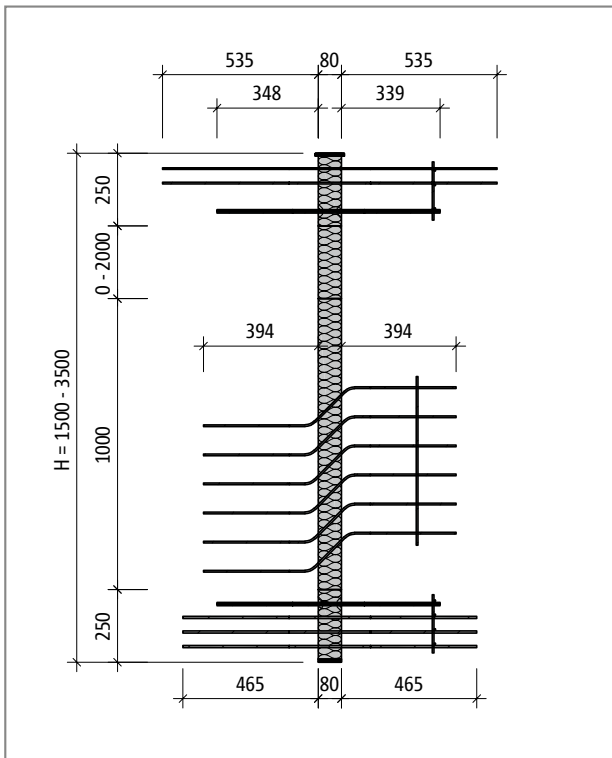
Schöck Isokorb® T Type W-M1 : Coupe du produit
